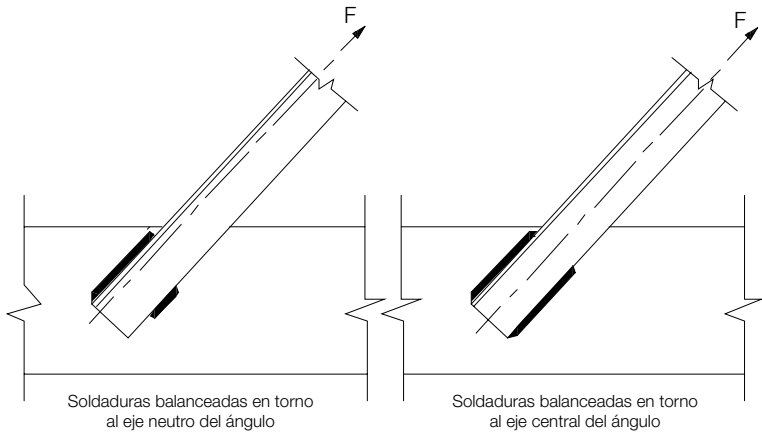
Soldaduras balanceadas.
